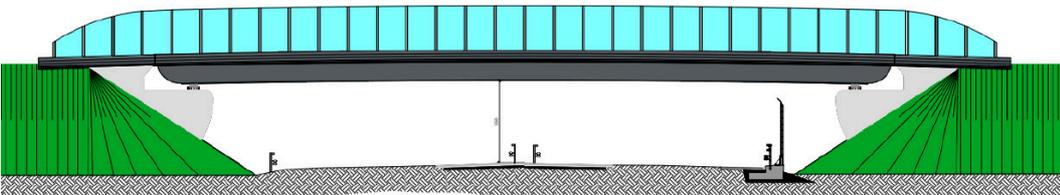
Prospetto attraversamento del sovrappasso (Fonte: Allegati alla Lista di controllo)
